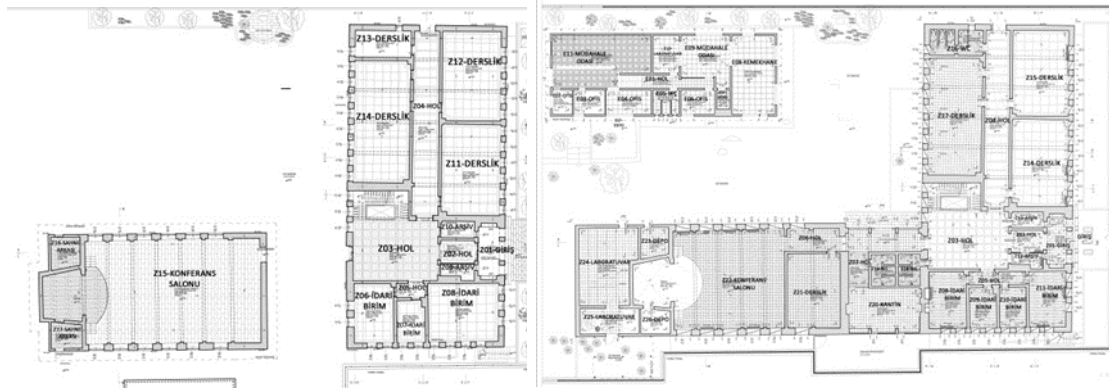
Yapının muhdes bağlantısı ve bahçeye sonradan yapılan niteliksiz yapı
